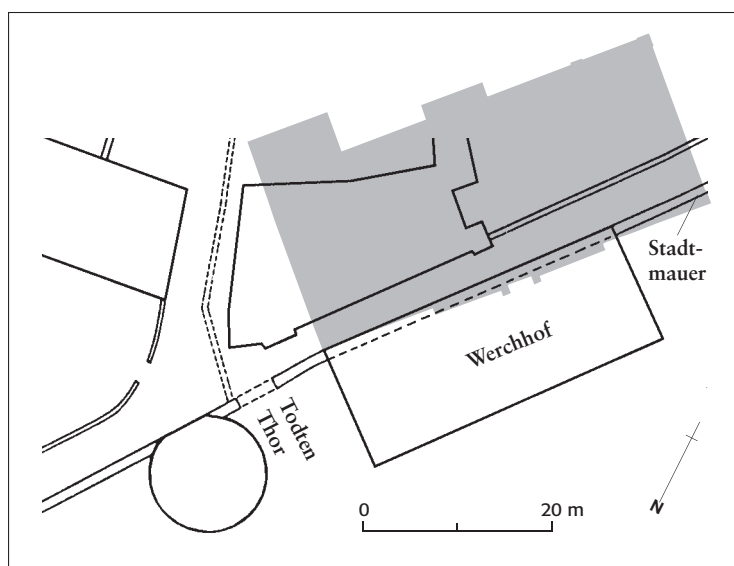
Chur, Grabenstrasse 35, Grabenschulhaus. Umzeichnung des Stadtplans von Peter Hemmi aus dem Jahre 1823 (Ausschnitt) mit Grundriss des Schulhauses (gerastert). Massstab 1:800.
